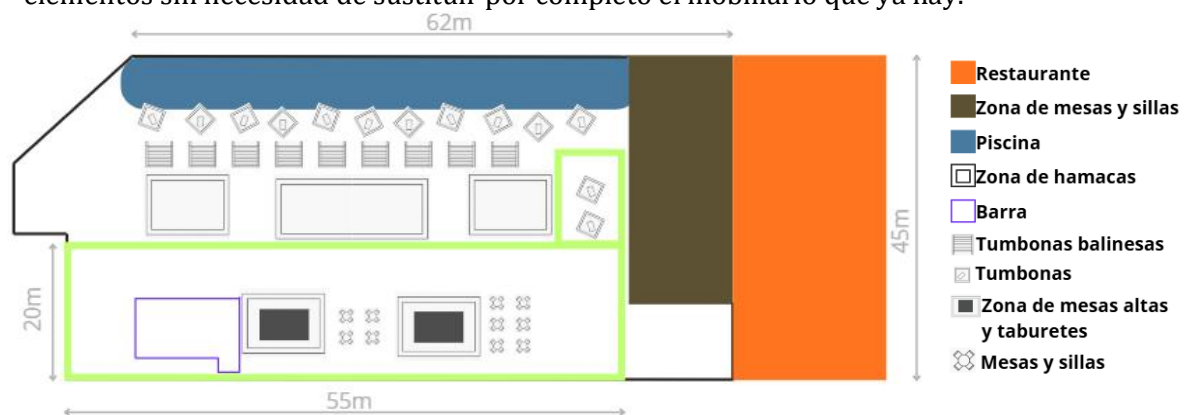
Plano esquemático de la terraza y delimitación de la zona chill out.
